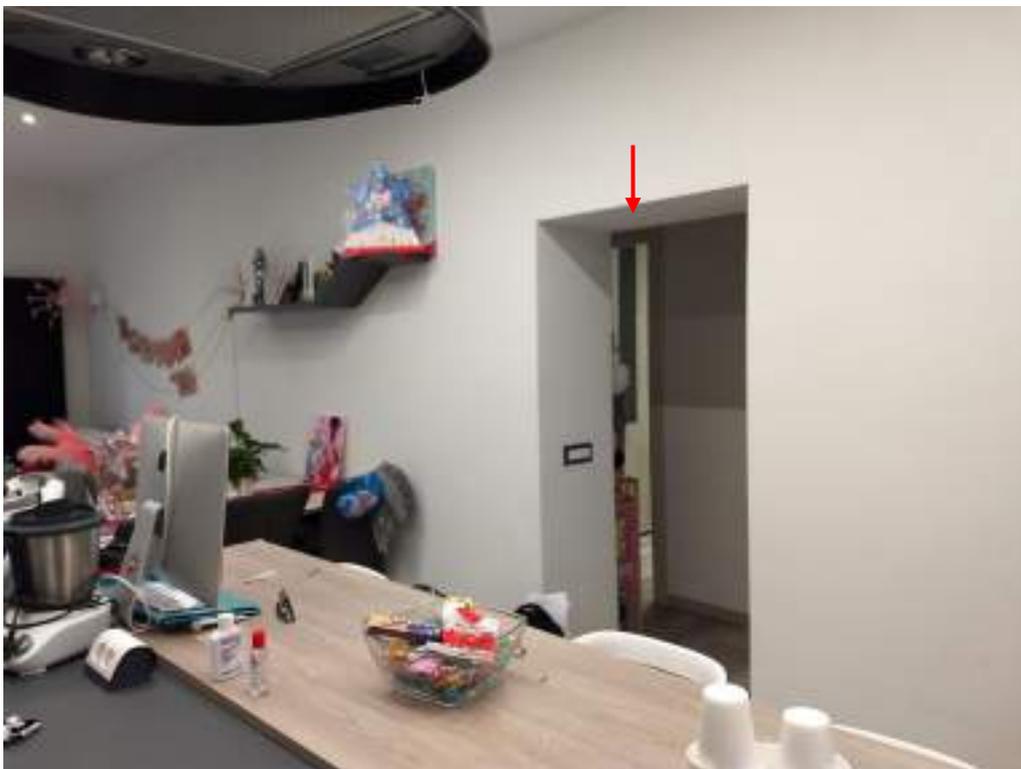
Vista interna del locale soggiorno verso il vano porta di ingresso al disimpegno zona notte e servizi.
